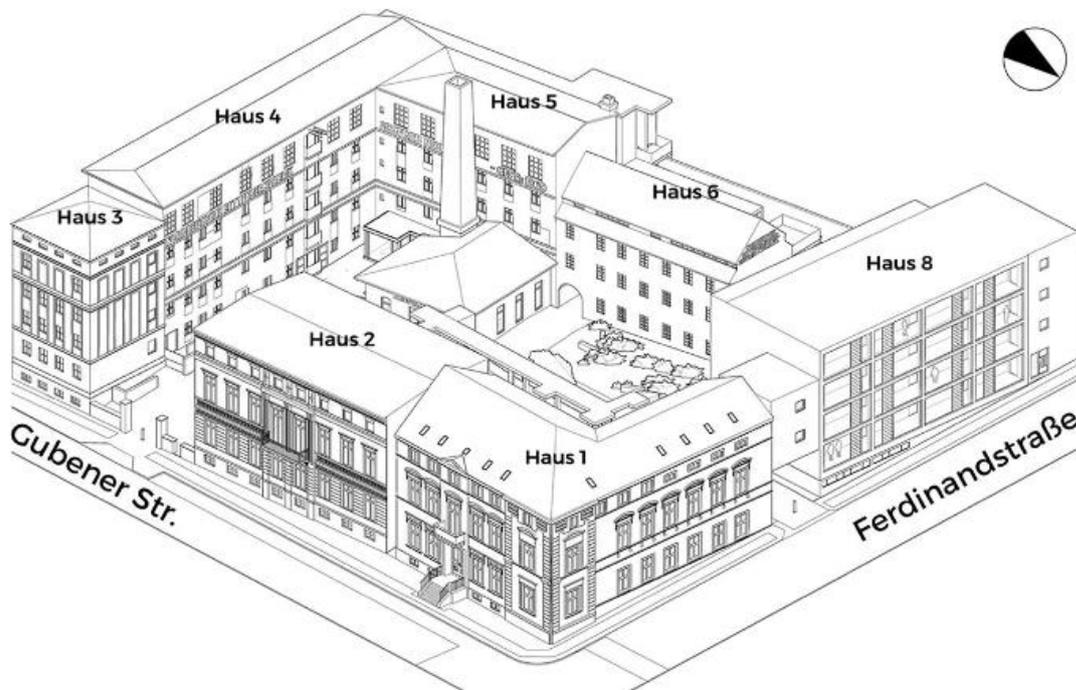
Übersicht FerdinandsHöfe Bestand (Haus 1 bis 6) und Neubau (Haus 8)
